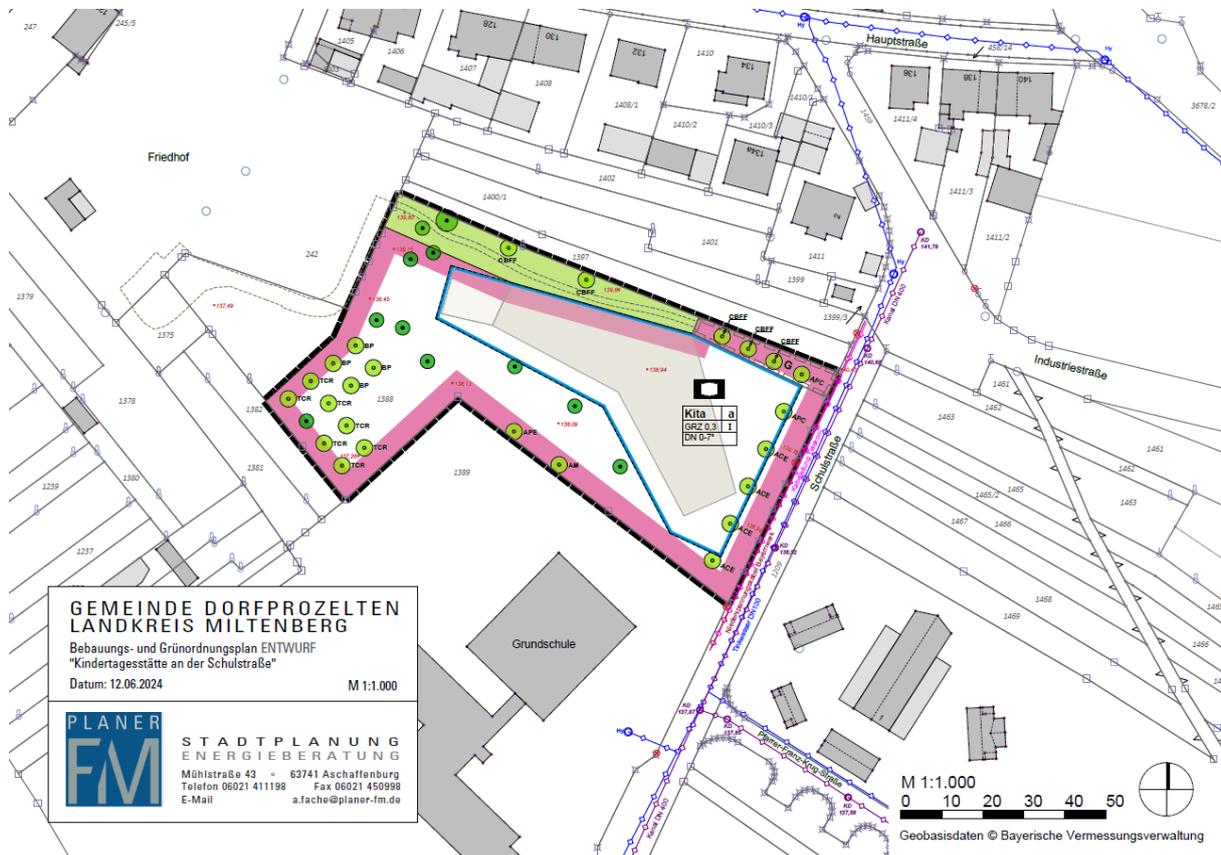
Entwurf Bebauungsplan „Kindertagesstätte an der Schulstraße“ (FM Planer, Stadtplanung, Energieberatung, Aschaffenburg, 12.06.24)
